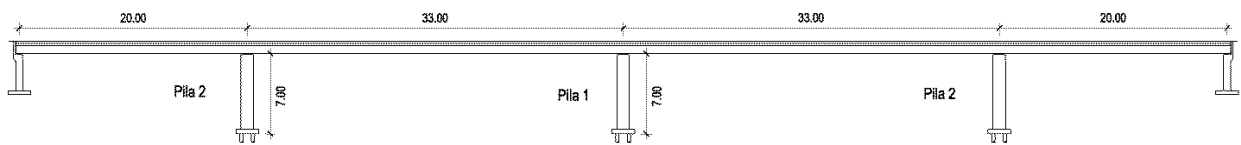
Alzado (Puente continuo cuatro vanos)
